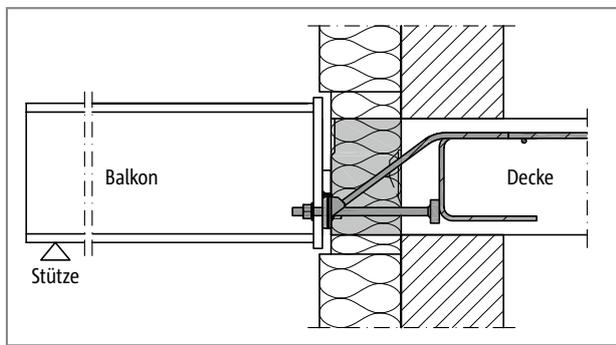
Schöck Isokorb® XT Typ SQ: Anschluss an die Stahlbetondecke; Dämmkörper innerhalb der Außendämmung
